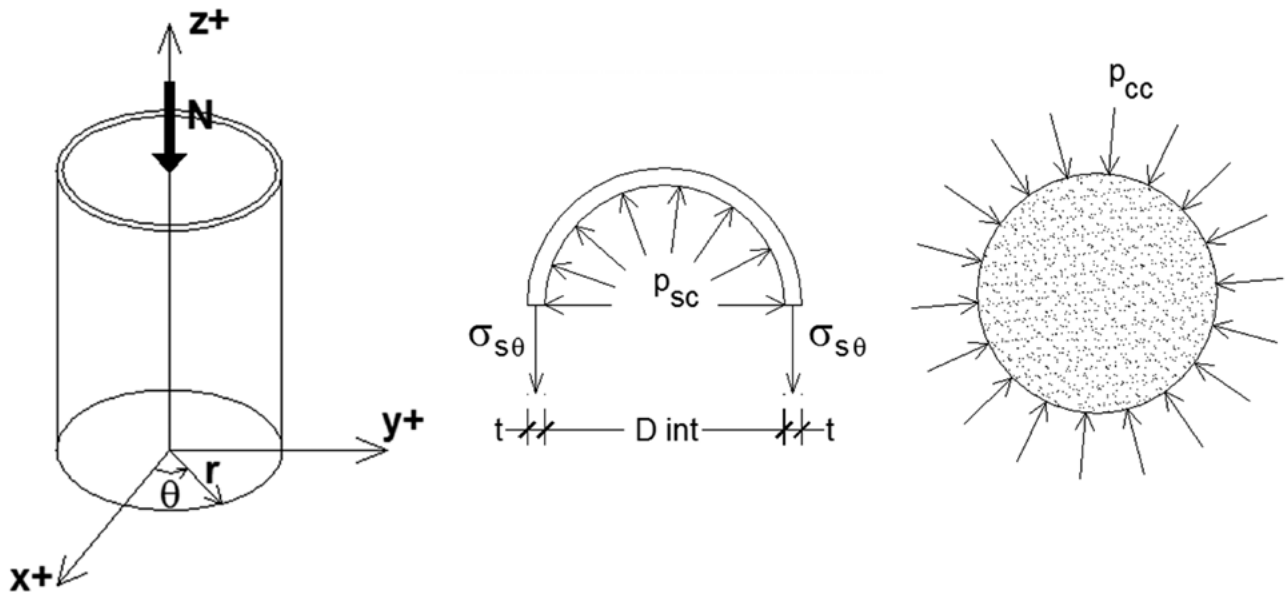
Tensiones en la sección transversal del tubo de acero y del núcleo de hormigón.
